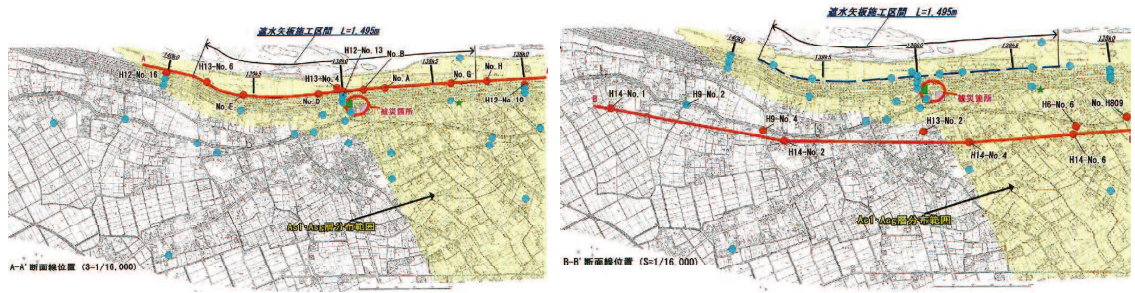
基礎地盤土質縦断図の作成位置 (左 : A-A'断面 右 : B-B'断面)
